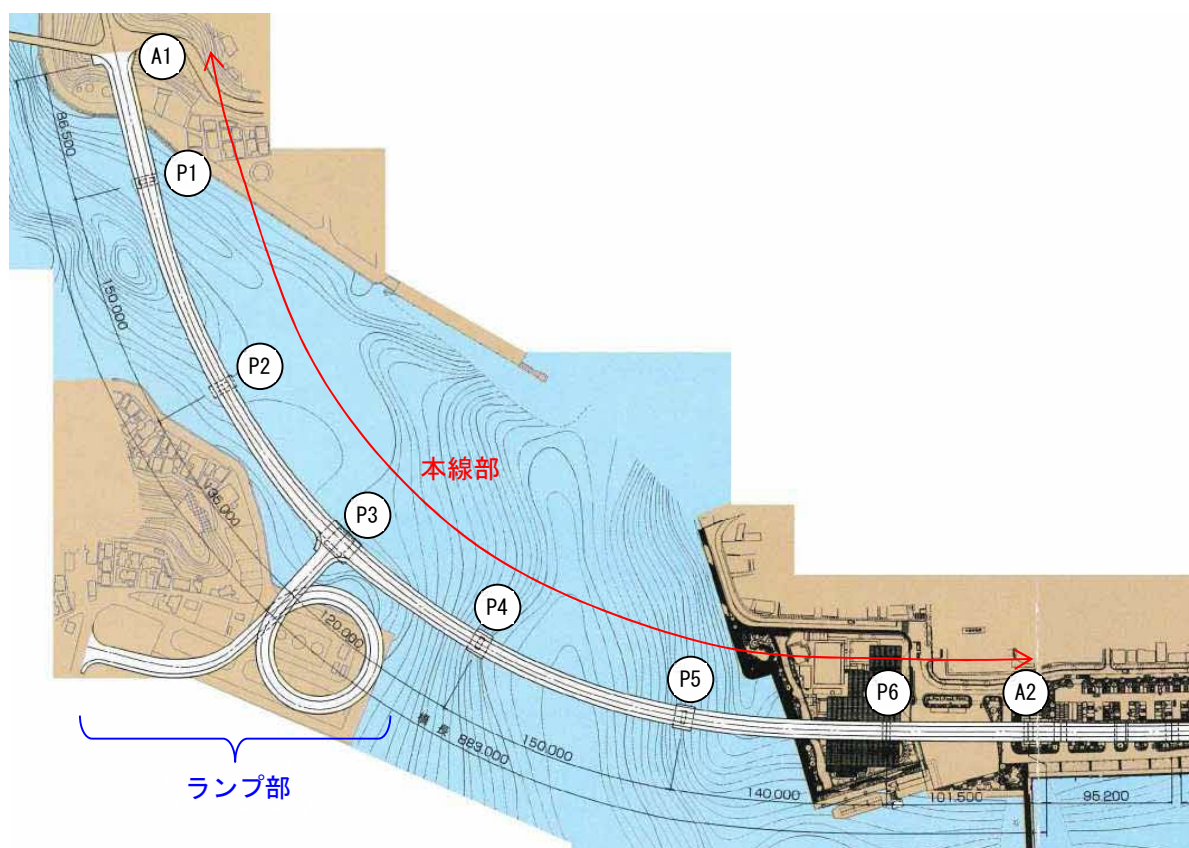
牛深ハイヤ大橋の平面図（パンフレットより）
